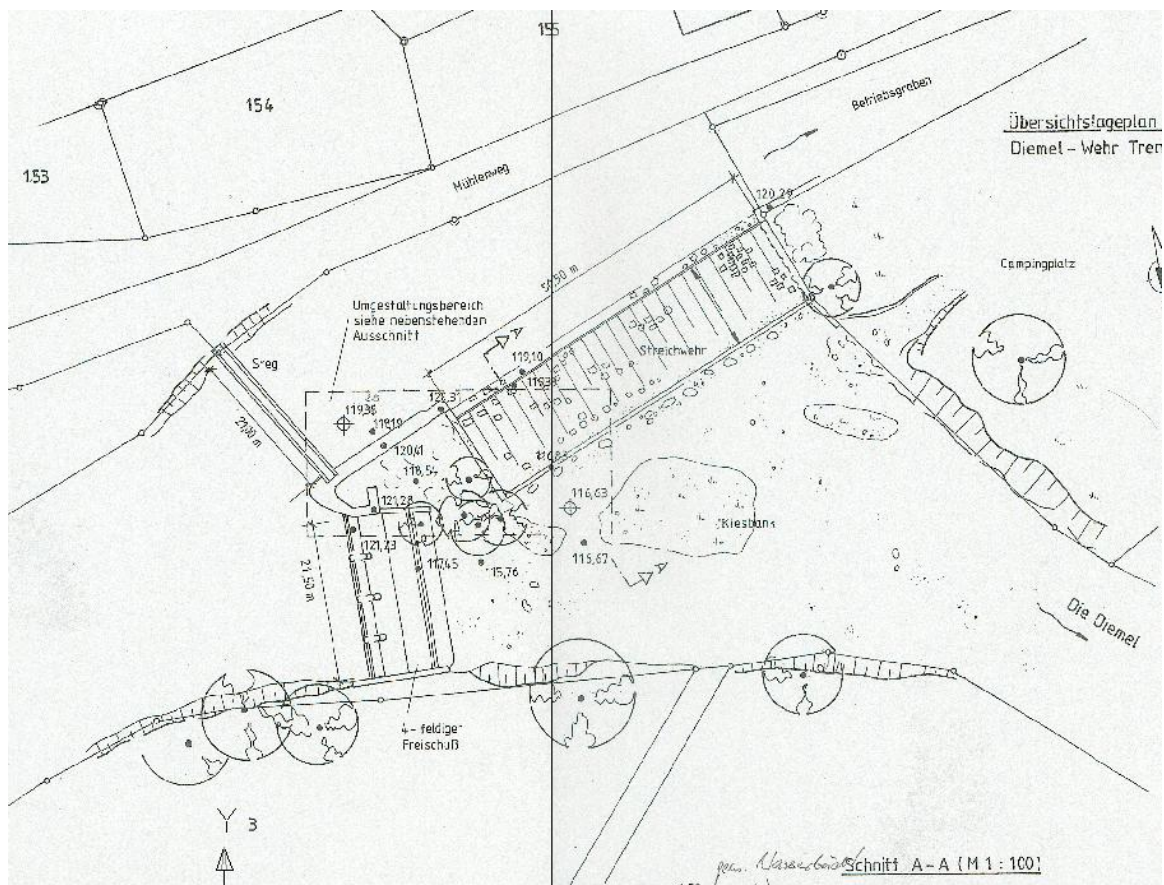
Lageplan Wehr und FAA Trendelburg
